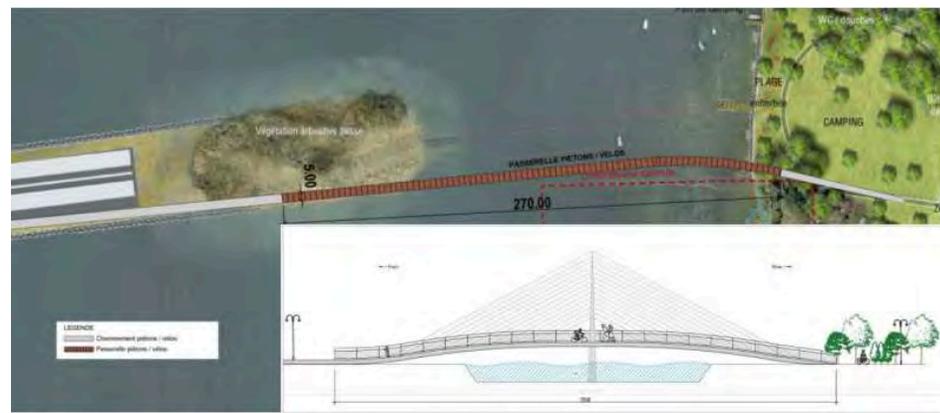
Raccordement sur la rive gauche par une passerelle surélevée
